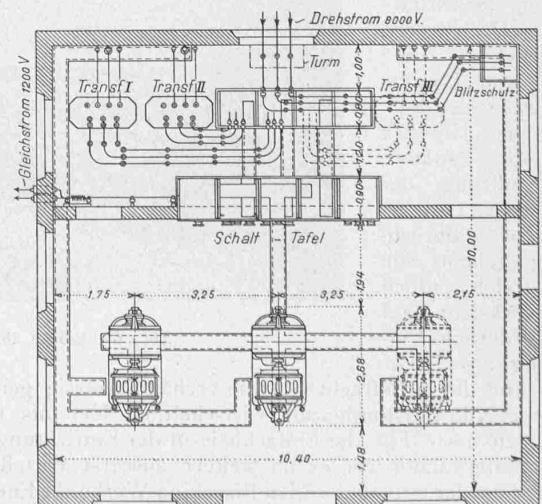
Grundriss der Umformerstation. — Masstab 1:150.
